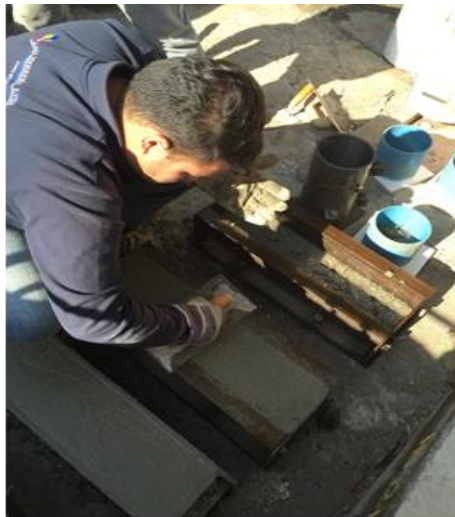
Probetas de hormigón durante el proceso de terminación.
